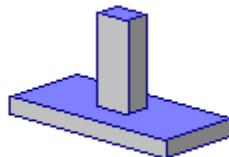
Zapata Aislada, Concreto, Rectangular, Sección Constante, Interna
